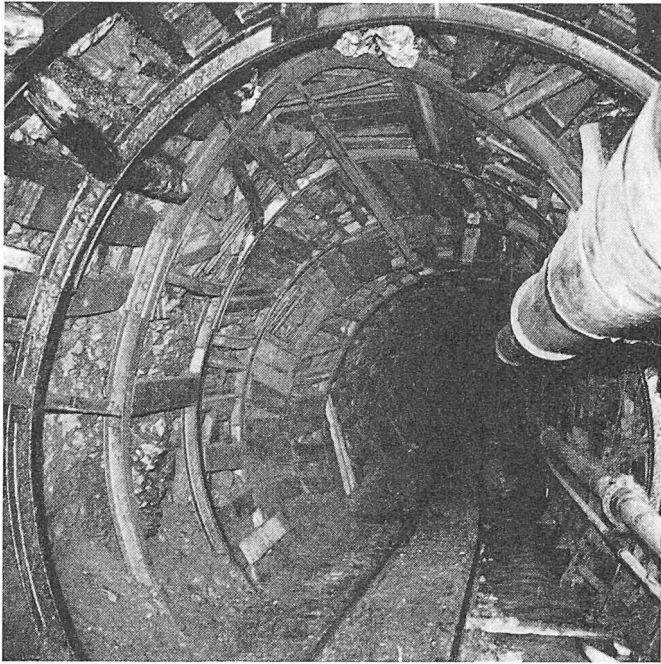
Stark deformierter Stahleinbau im Vortrieb
